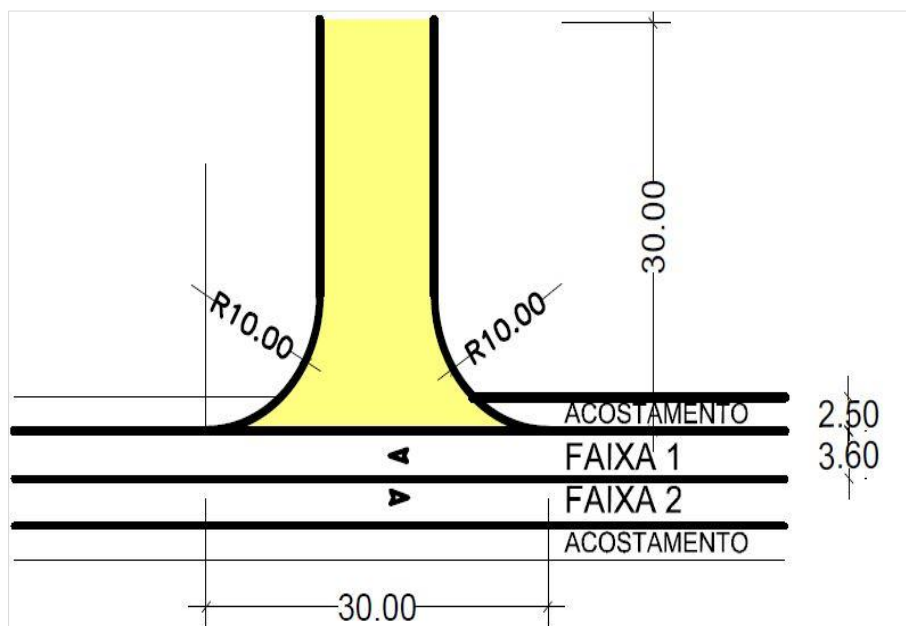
Acesso Tipo 1 | Geometria e Pavimentação
